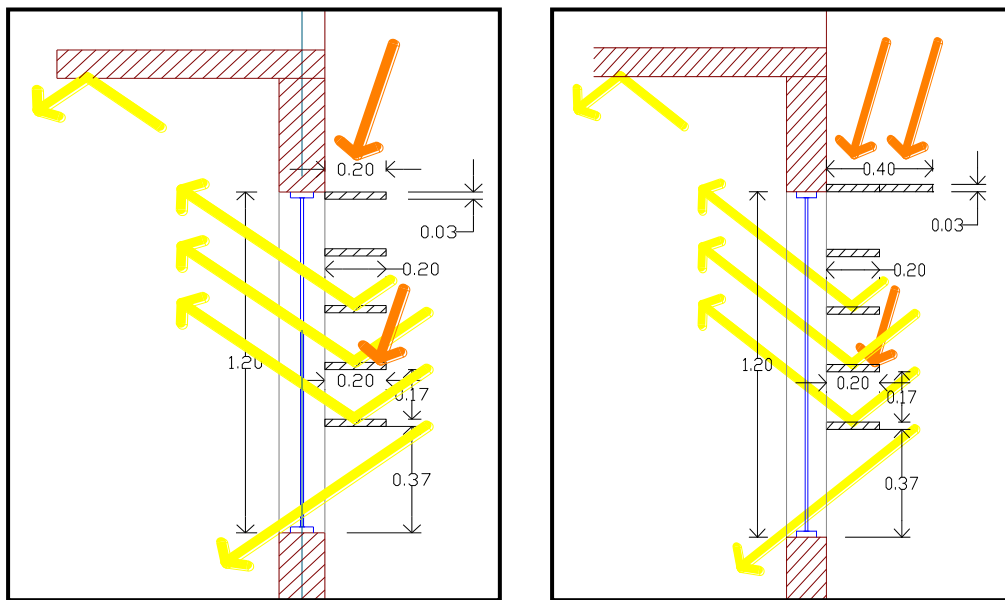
Detalles de las distintas propuestas sobre la fachada sur.
